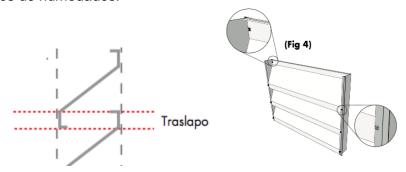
Cerramiento perimetral propuesto por la consultoría (izquierda). Cerramiento perimetral propuesto por Ecopetrol (derecha)
